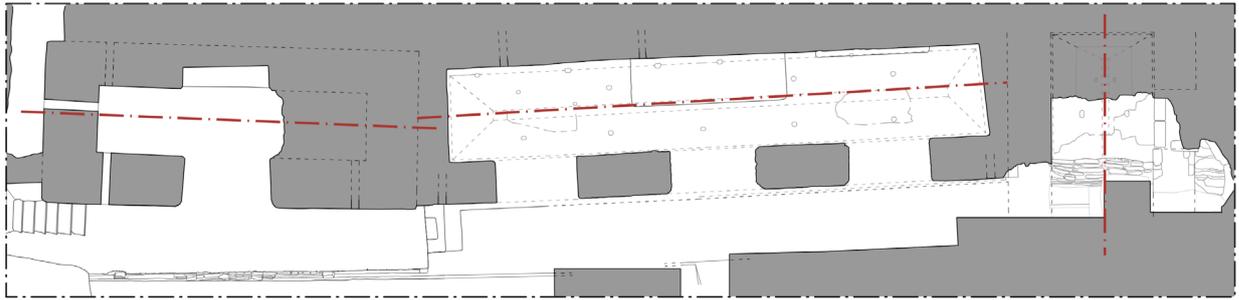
Planta general de la subestructura con los diferentes ejes de las tres estancias.
